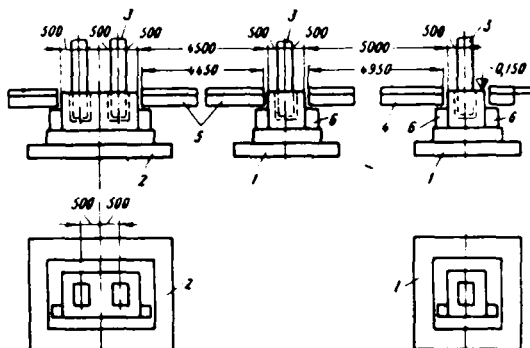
Фундаменты и фундаментные балки для зданий с шагом колонн 6 м
